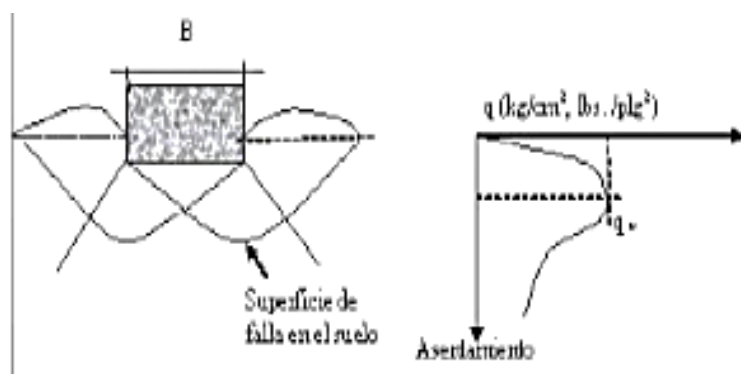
Falla General por Corte. (Fuente: Vesic, 1973).
